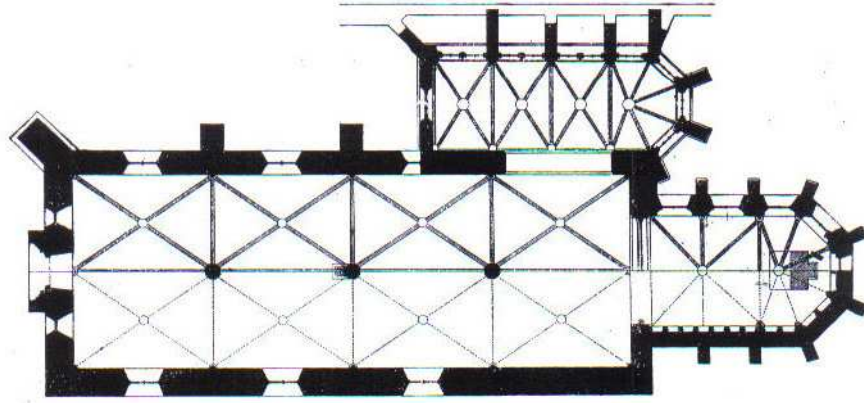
Grundriss der ehemaligen Klosterkirche Imbach mit Katharinenkapelle
